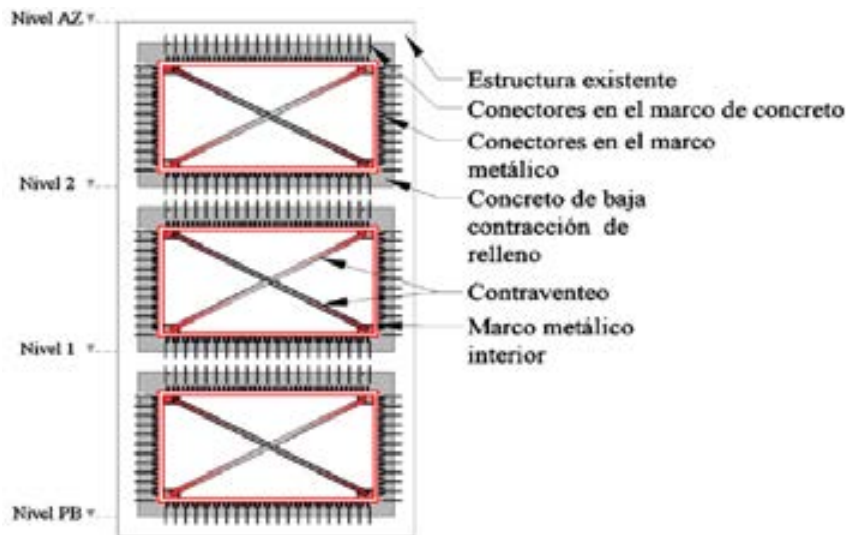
Contraventeo dentro de la cruzía de un marco de concreto
